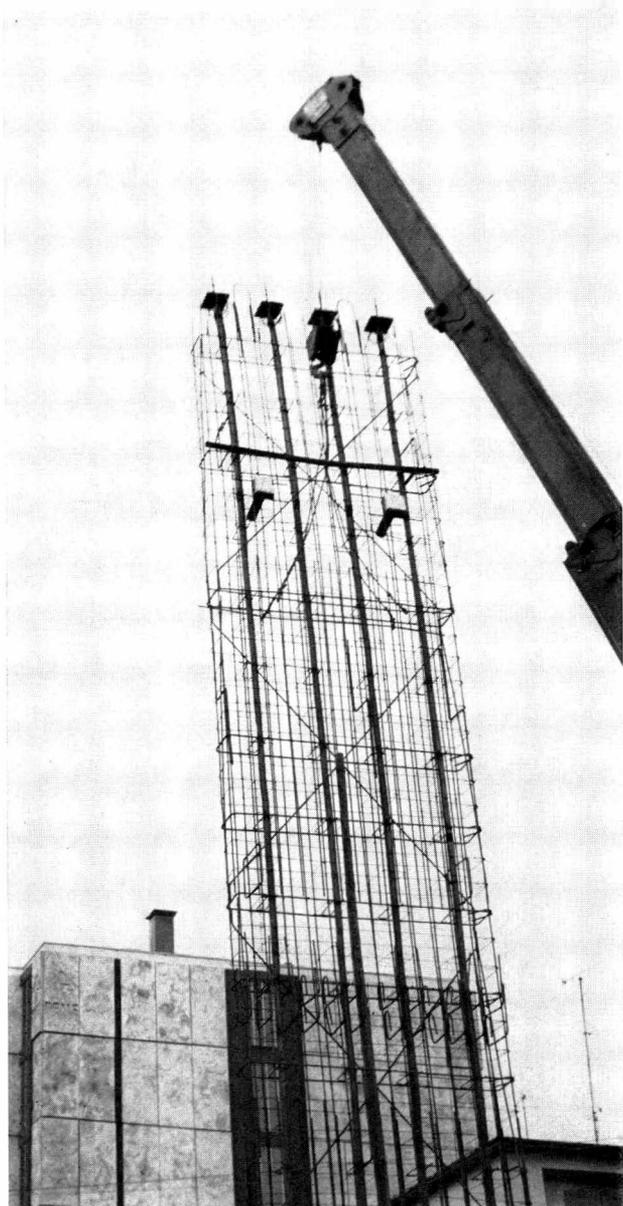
Vorgespannte Schlitzwände, Armierungskorb
